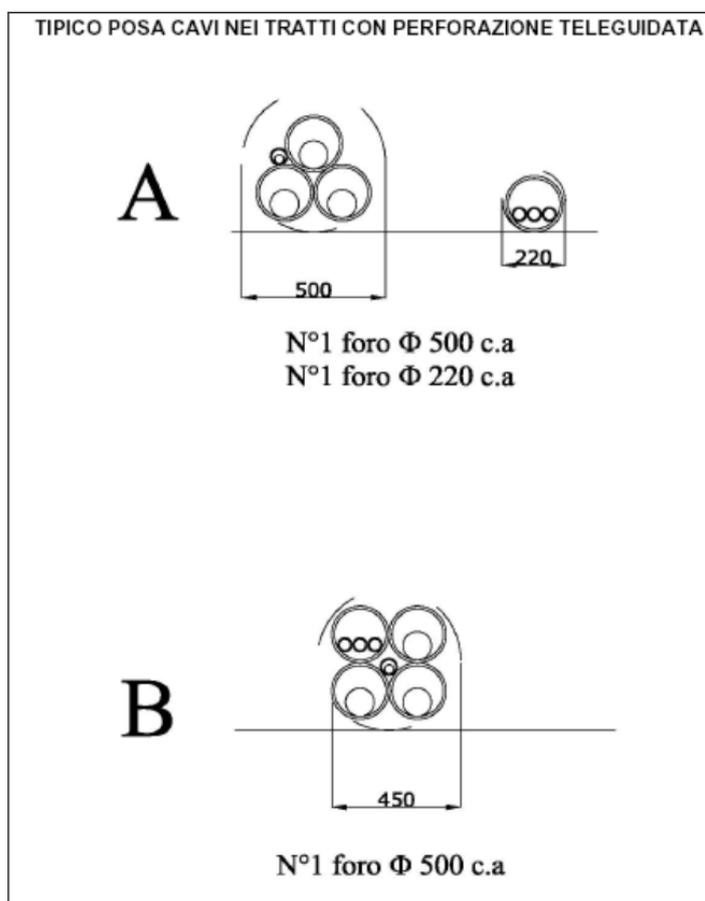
Sezione Tipo Attraversamento con foro pilota
